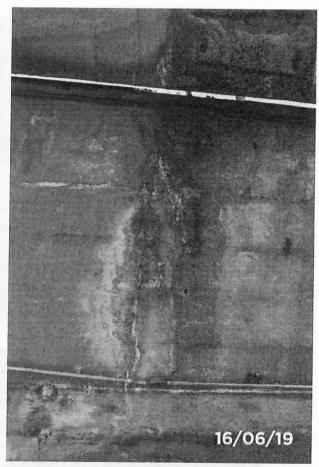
Detalhe da fissura gerando infiltração e eflorescência no encontro com a passarela.
